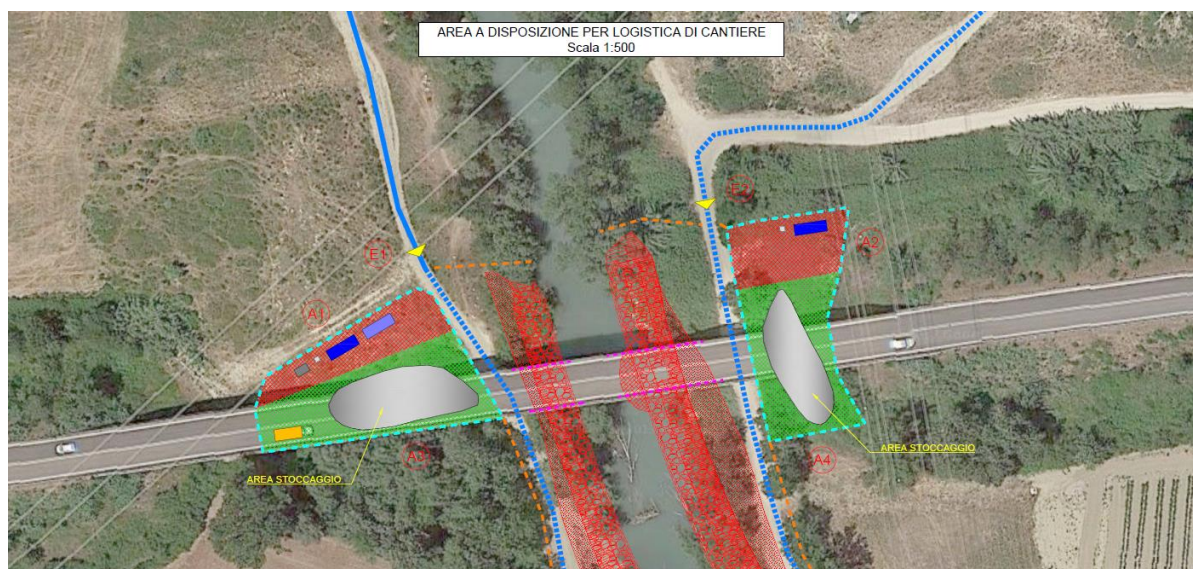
Stralcio Planimetria di cantierizzazione – Progetto esecutivo - interventi di adeguamento e messa in sicurezza urgente – Aree a disposizione per logistica di cantiere
